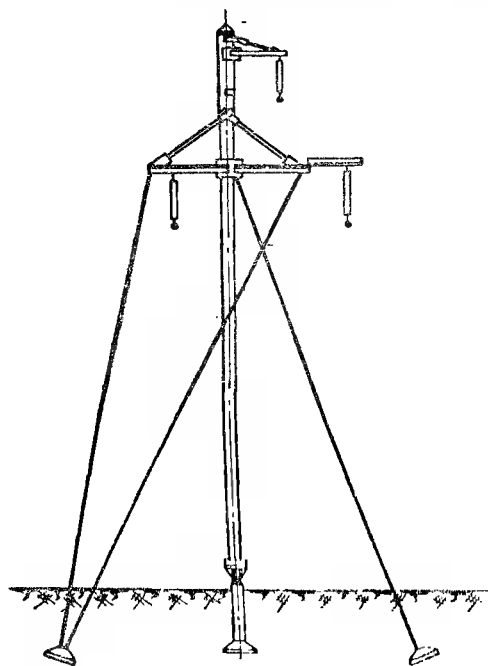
Угловая железобетонная повышенная опора на оттяжках.
